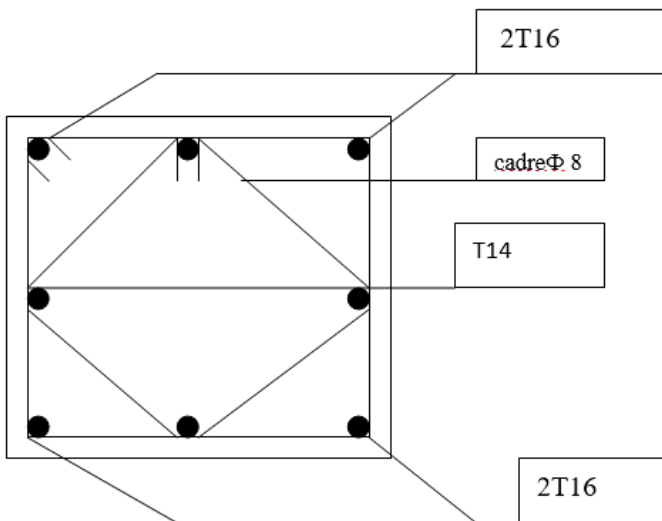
Schéma de ferrailage des poteaux (40\*40)
